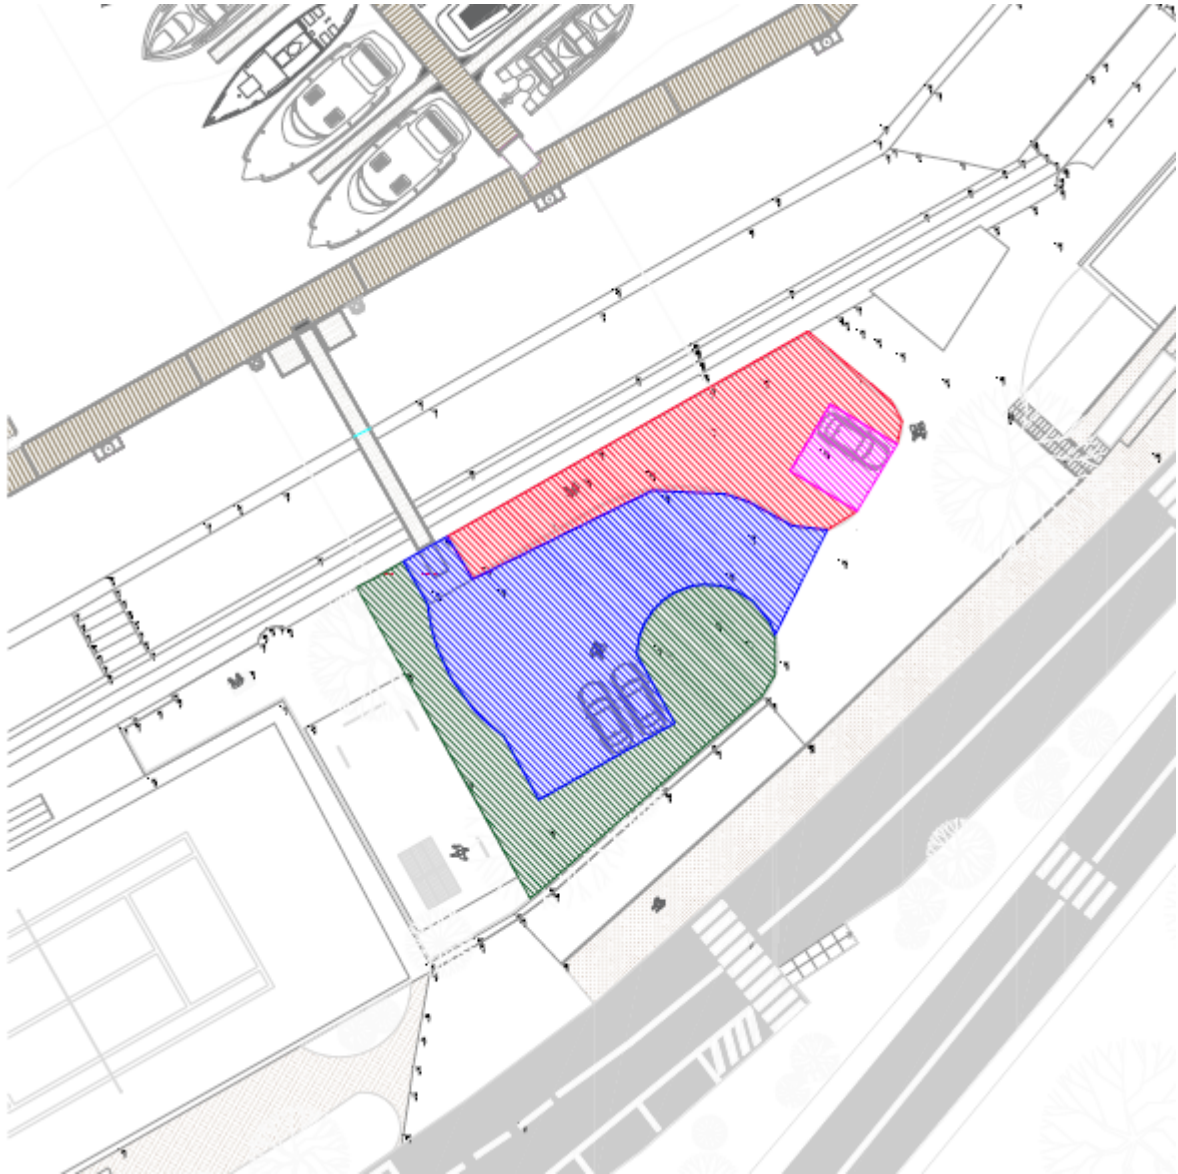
Planimetria di progetto con le trasformazioni di superficie
